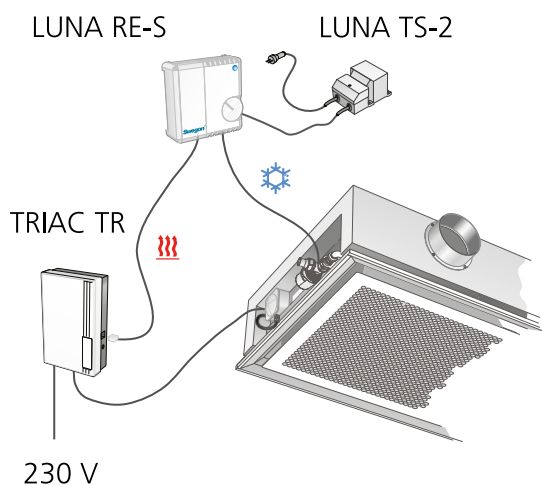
Installazione, raffreddamento ad acqua e riscaldamento elettrico
